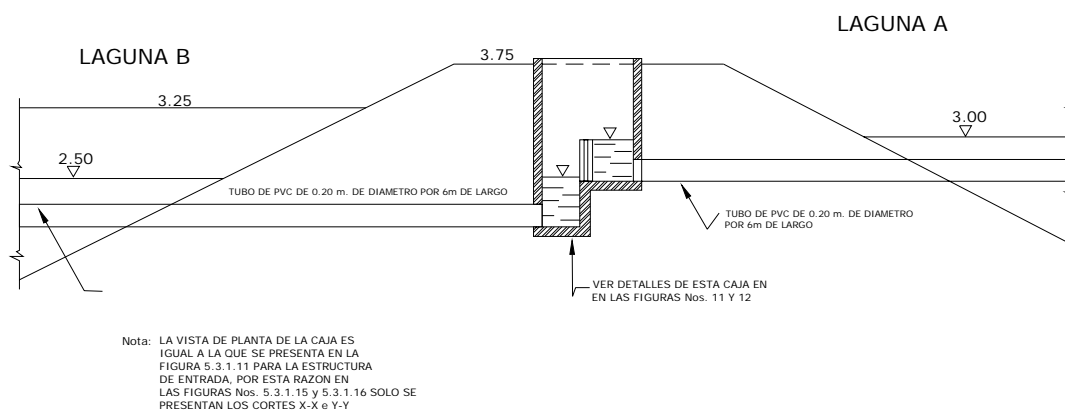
Detalle de la estructura de interconexión entre las lagunas A y B. Obra de arte No3.
